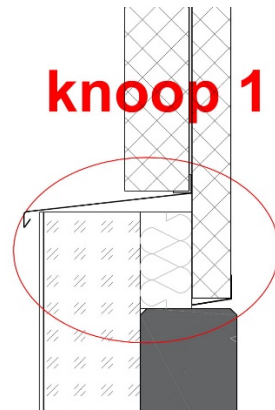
Plint knoop 1 (Detail 2A) ter hoogte van de overgang van wand naar sokkel in opbouw 2A (Sandwichpanelen met buitenisolatie in sandwichpanelen)
